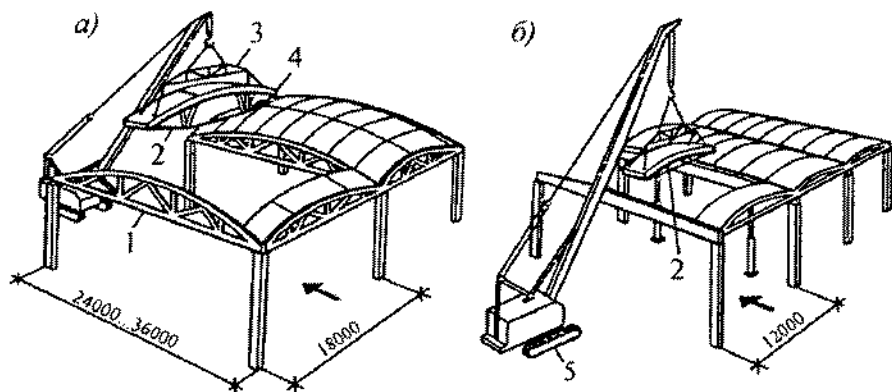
Монтаж элементов покрытия одноэтажных зданий при разных направлениях монтажа:
